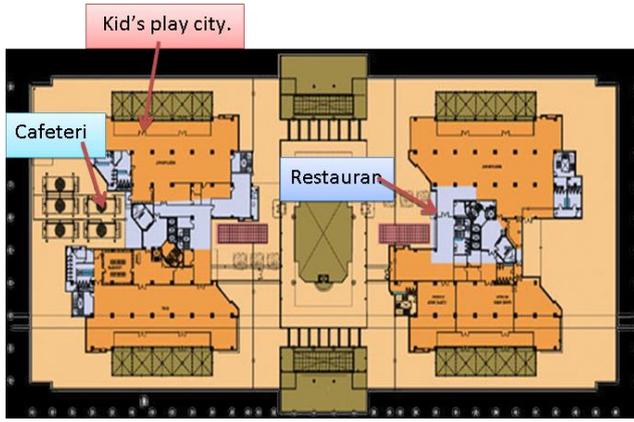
مسقط أفقي للطابق السفلي الادنى
